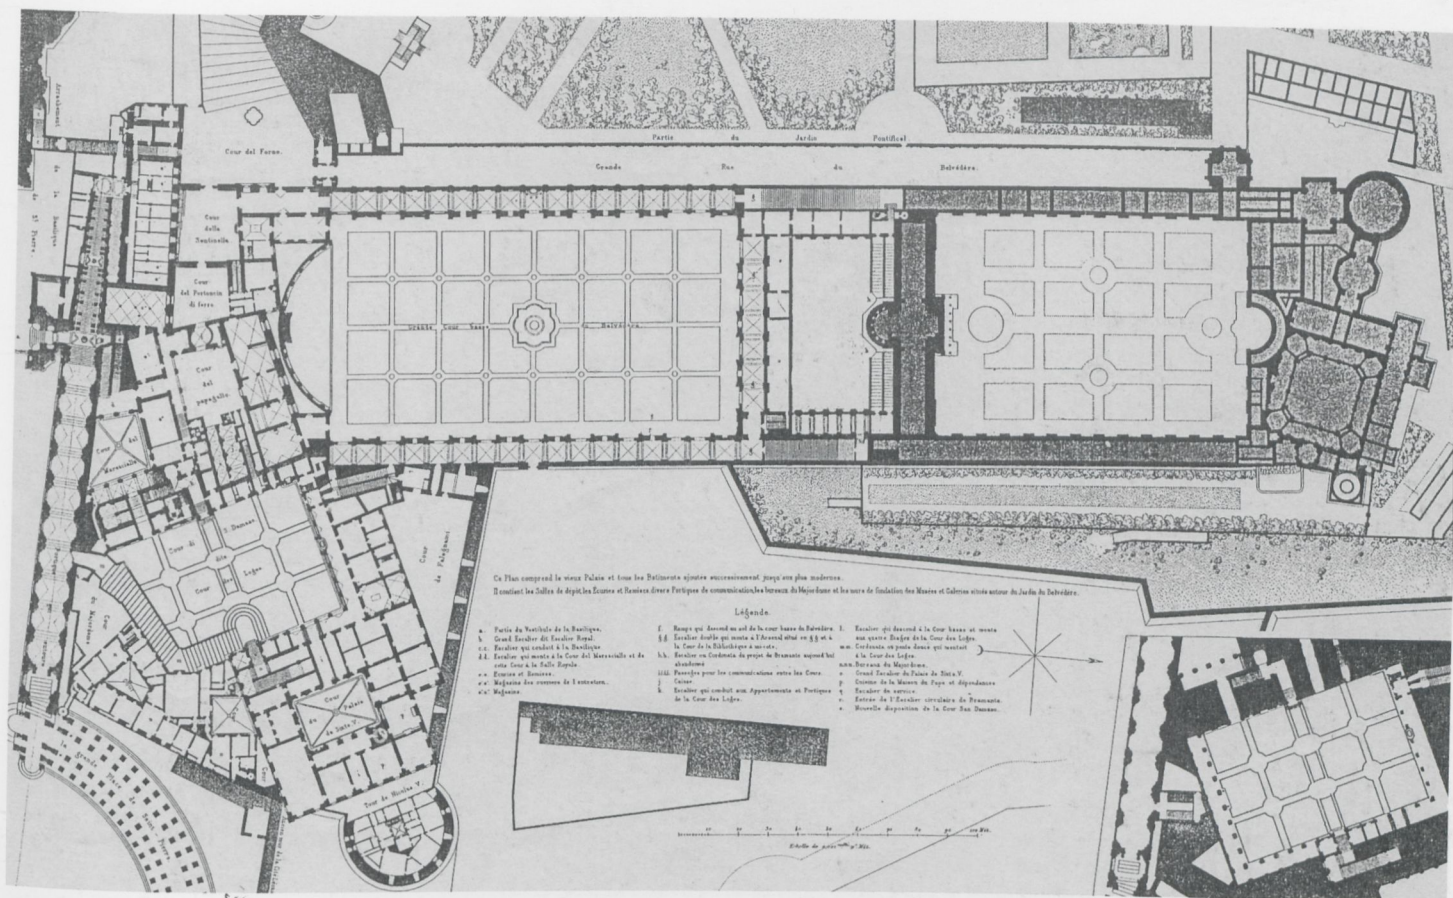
Paul Letaronilly, Pianta del pianterreno del Cortile del Belvedere (Le Vatican, tav. 113)
